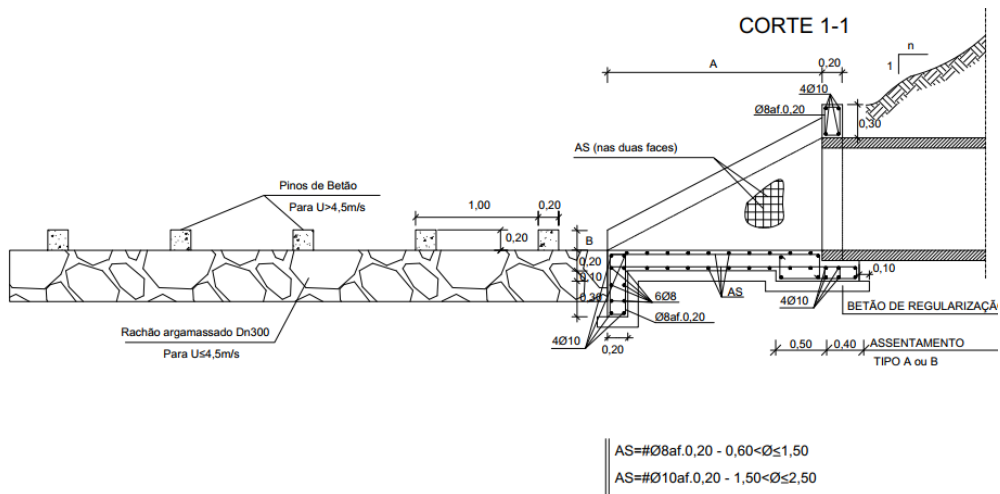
Corte 1 relativo à boca simples de aterro para passagem hidráulica em betão argamassado
